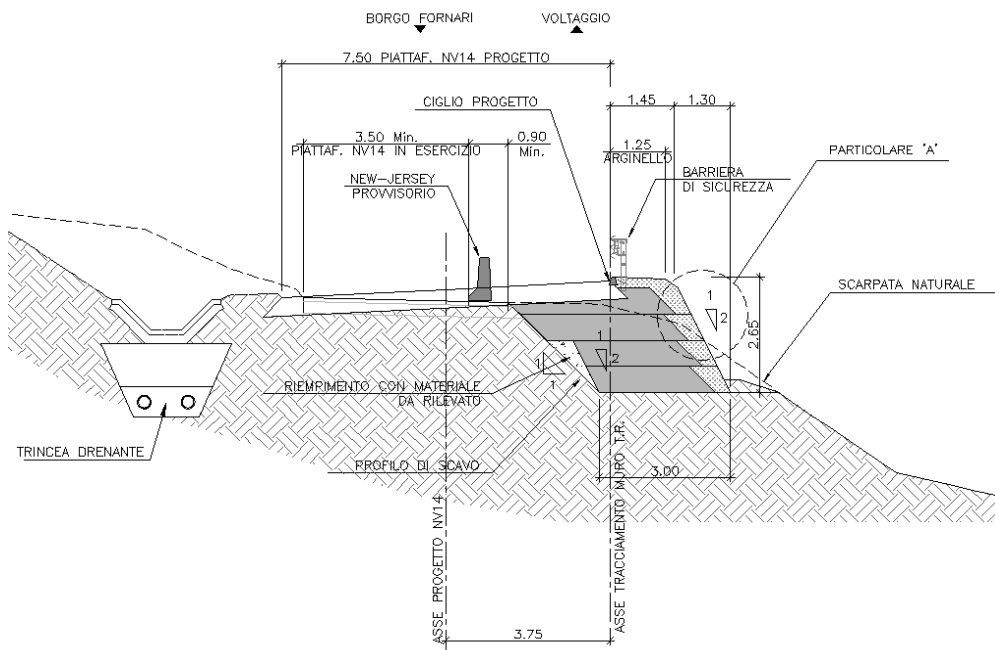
Sezione tipologica muro di sostegno MR02
